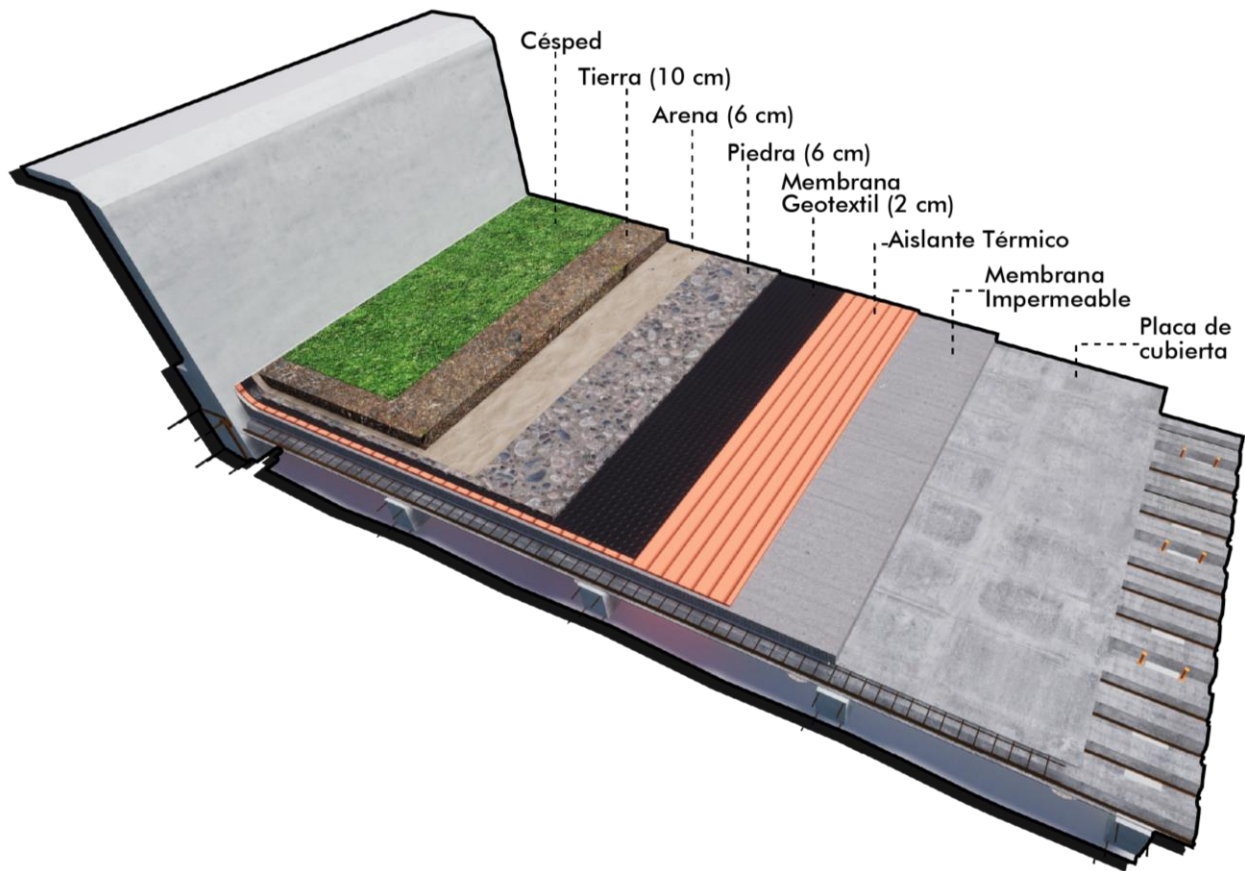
Detalle Cubierta Verde. Elaboración Propia.
